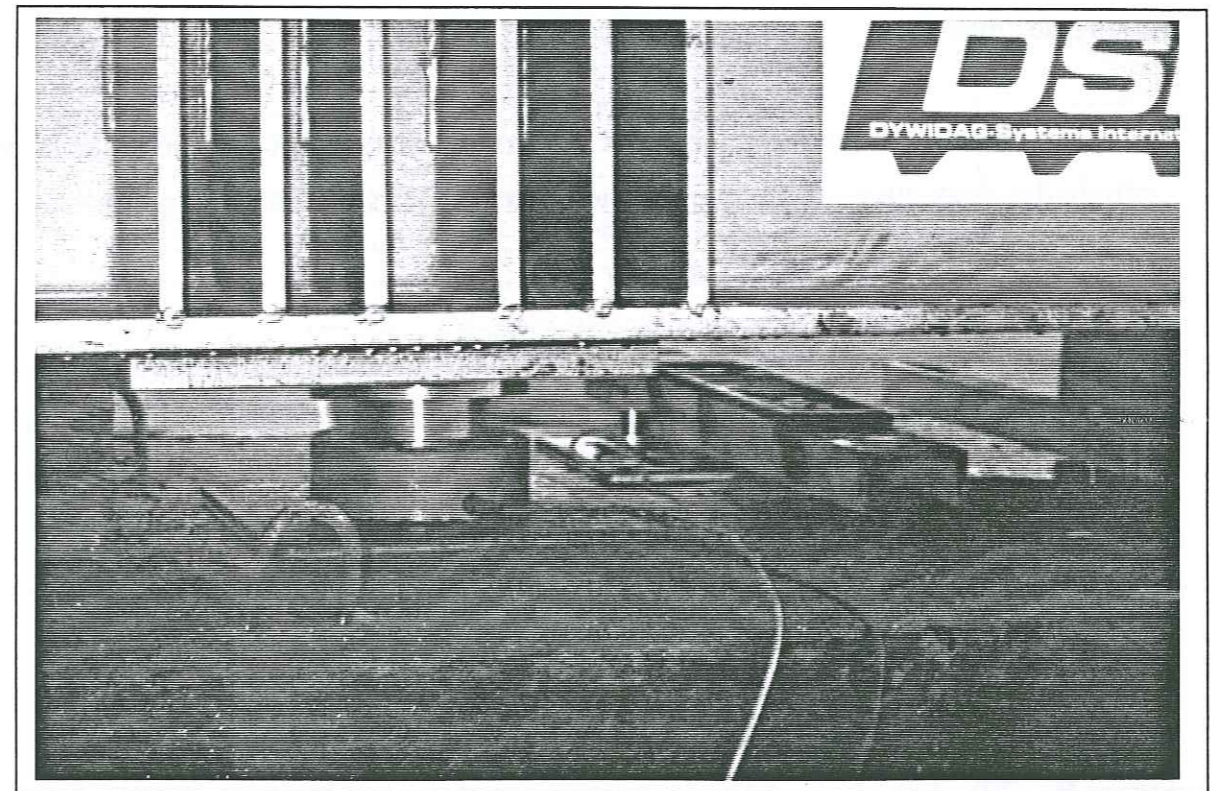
Peson calé entre chaque dalle et la poutre de chargement
